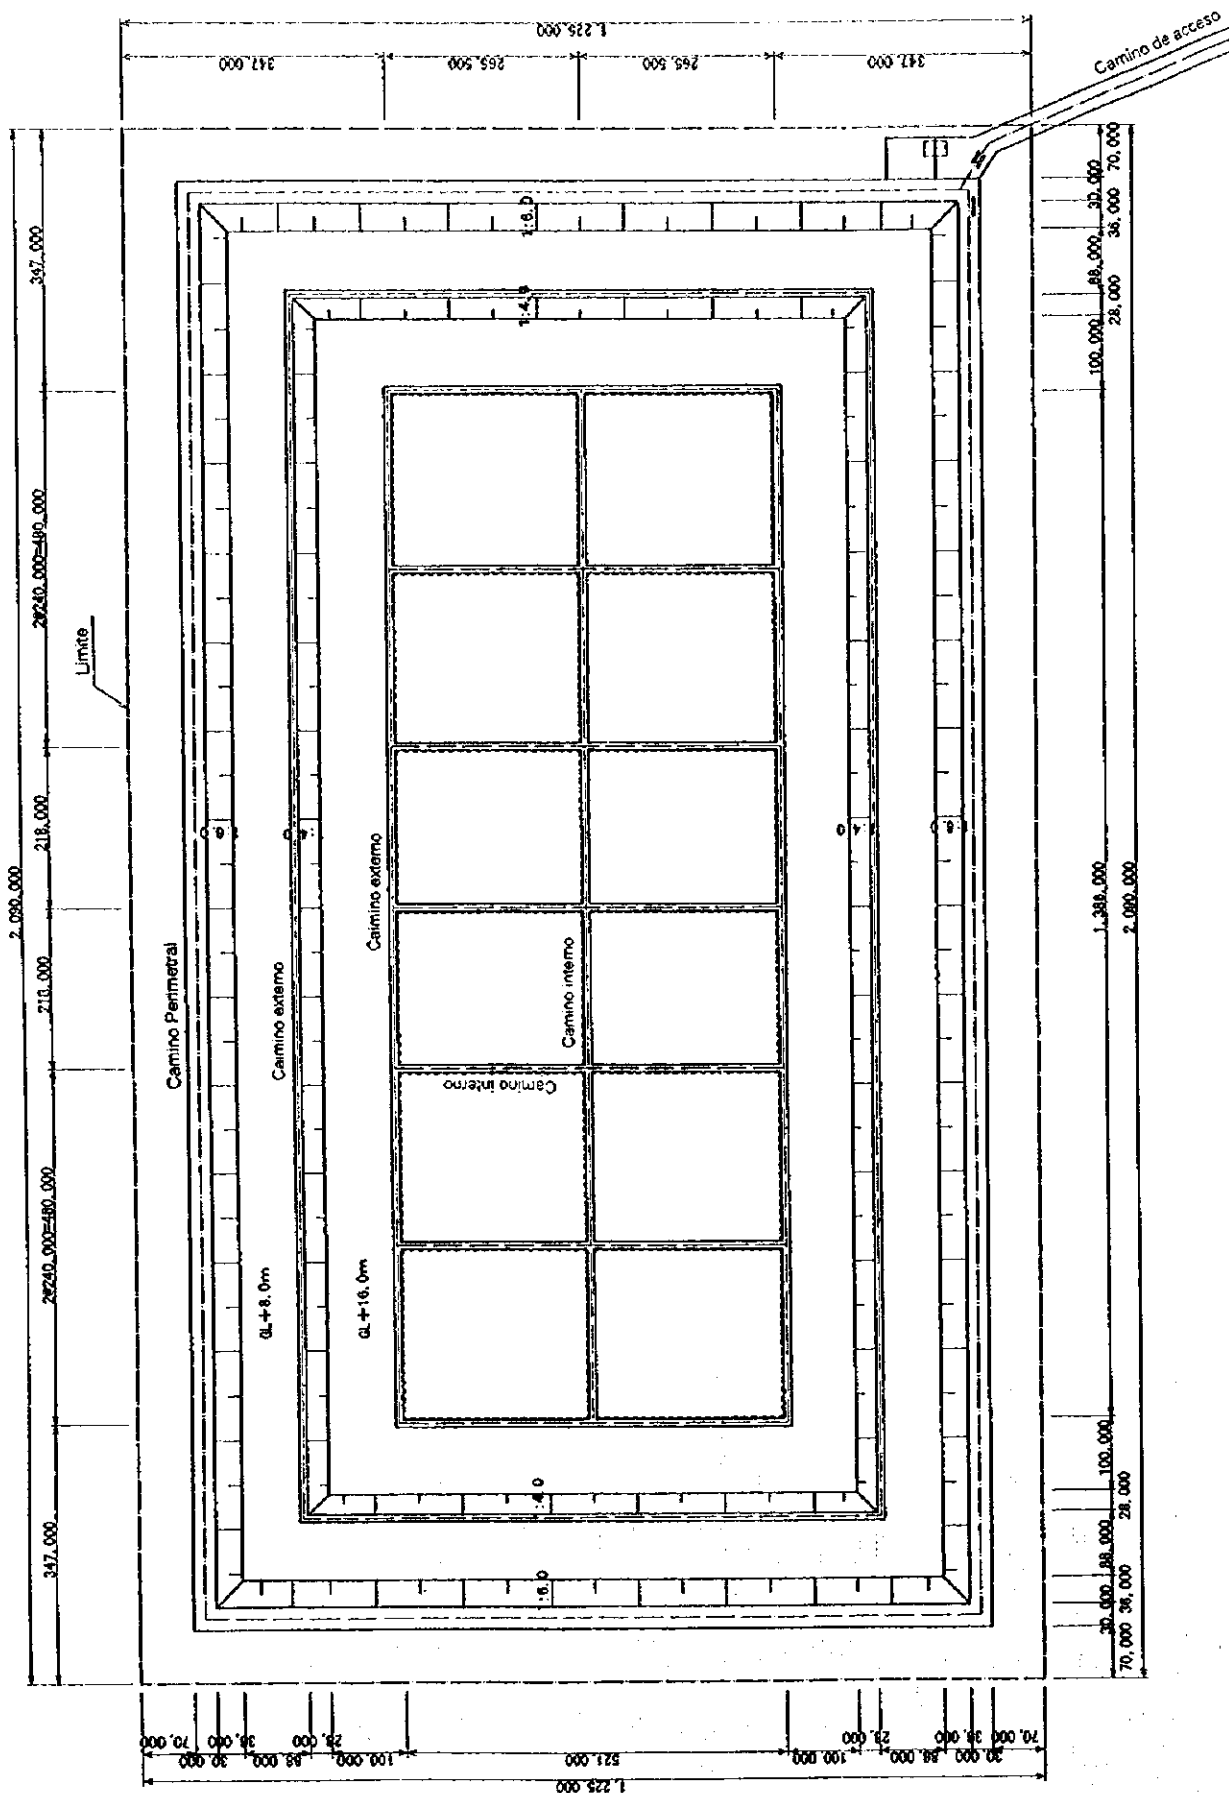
Plano de Planta del Tercer Nivel (16 m. de elevación)
